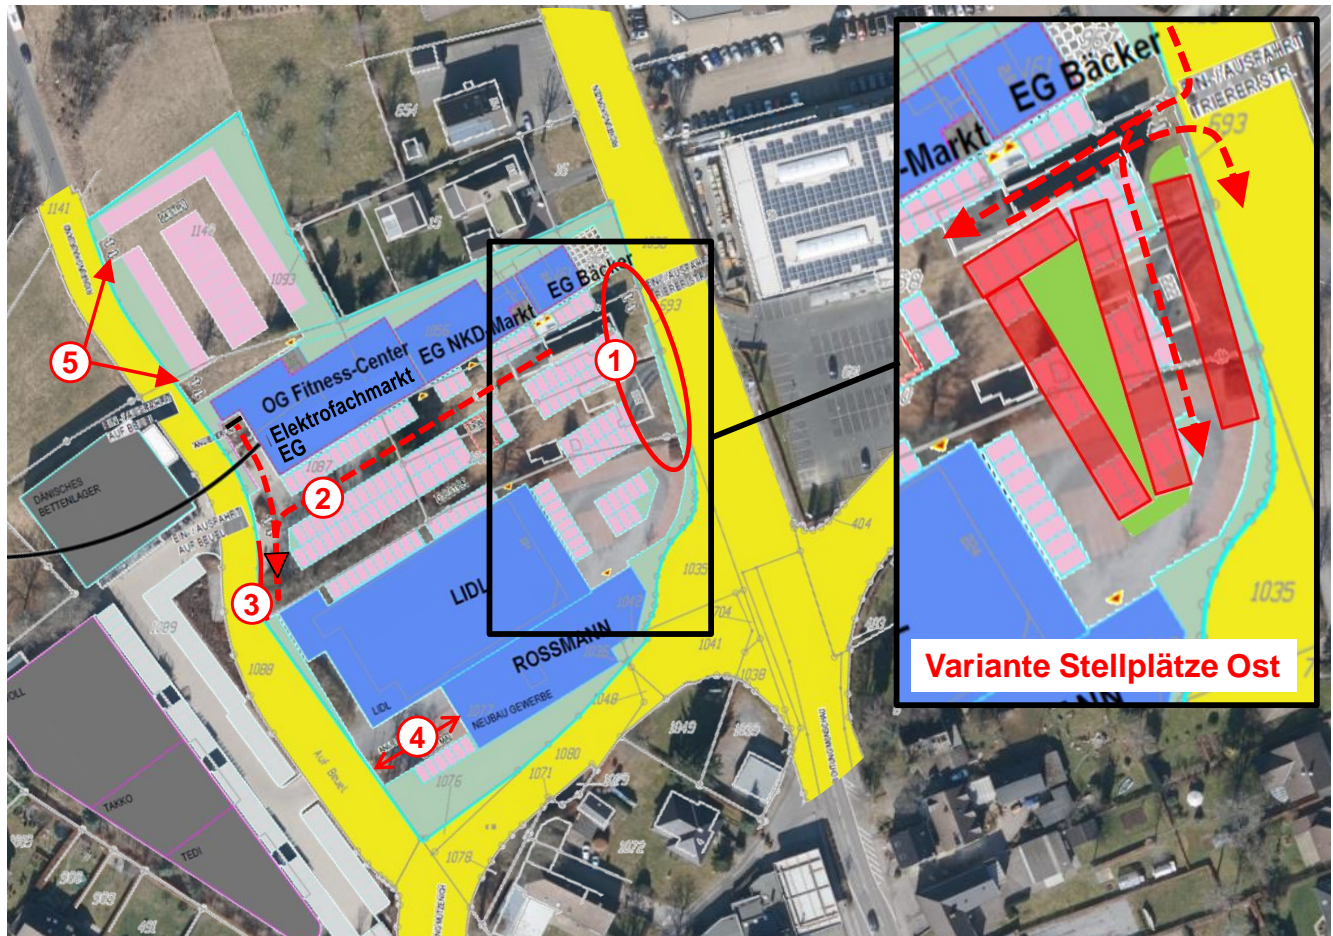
Planskizze als Grundlage zur Erstbewertung der äußeren und inneren Erschließung
